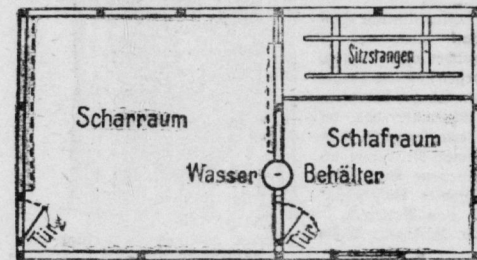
Grundriss eines vorteilhaften Hühnerstalles.
